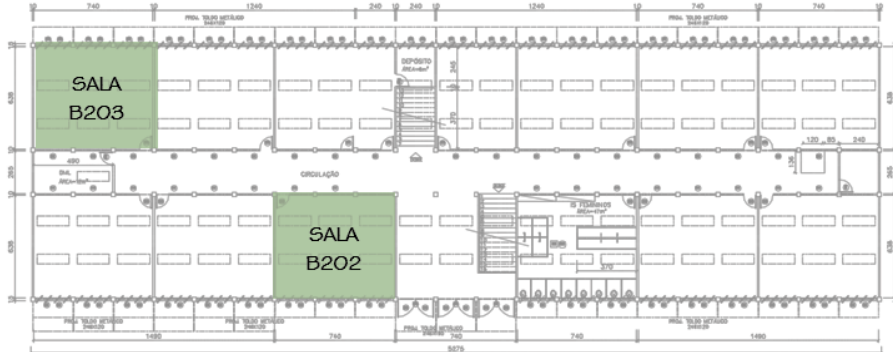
Planta Técnica Bloco 2– IFMG Santa Luzia
